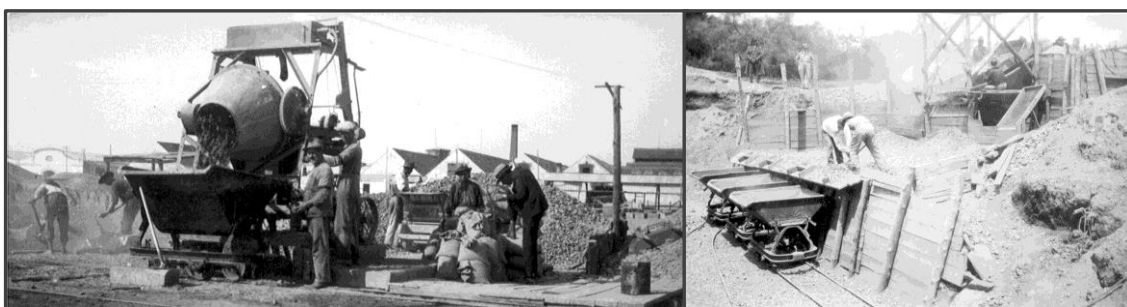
Central de produção de betão (com recurso à betoneira *Ransome*) e central de armazenamento e tratamento de inertes
